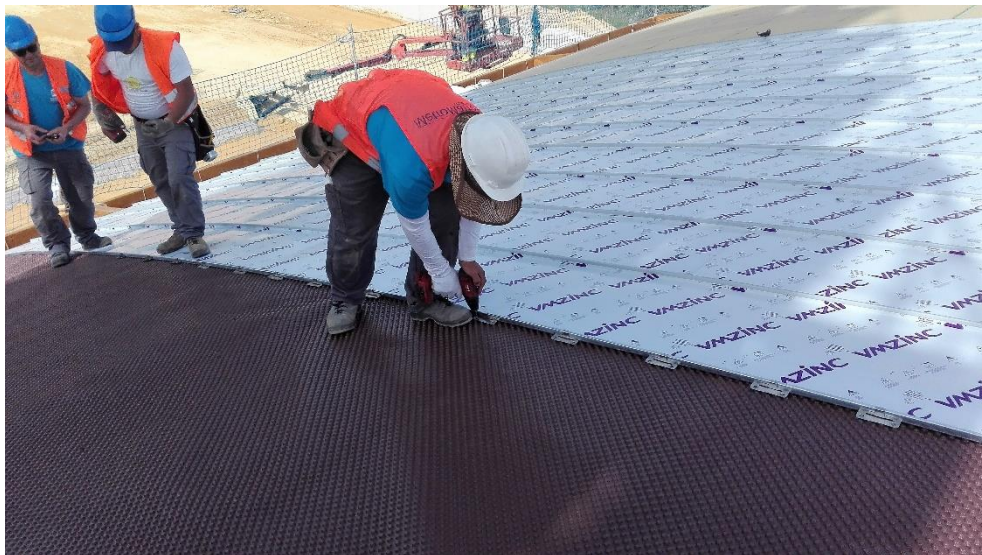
Vista chapas ya plegadas en sus extremos tras pasar por máquina plegadora. Fuente: Elaboración propia.
